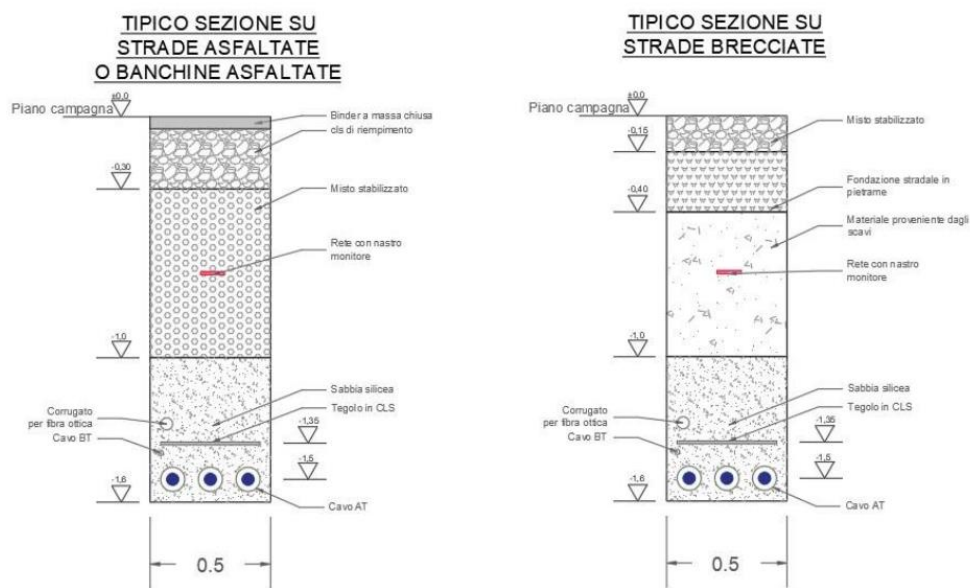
Sezioni tipiche di scavo – Cavidotto AT
